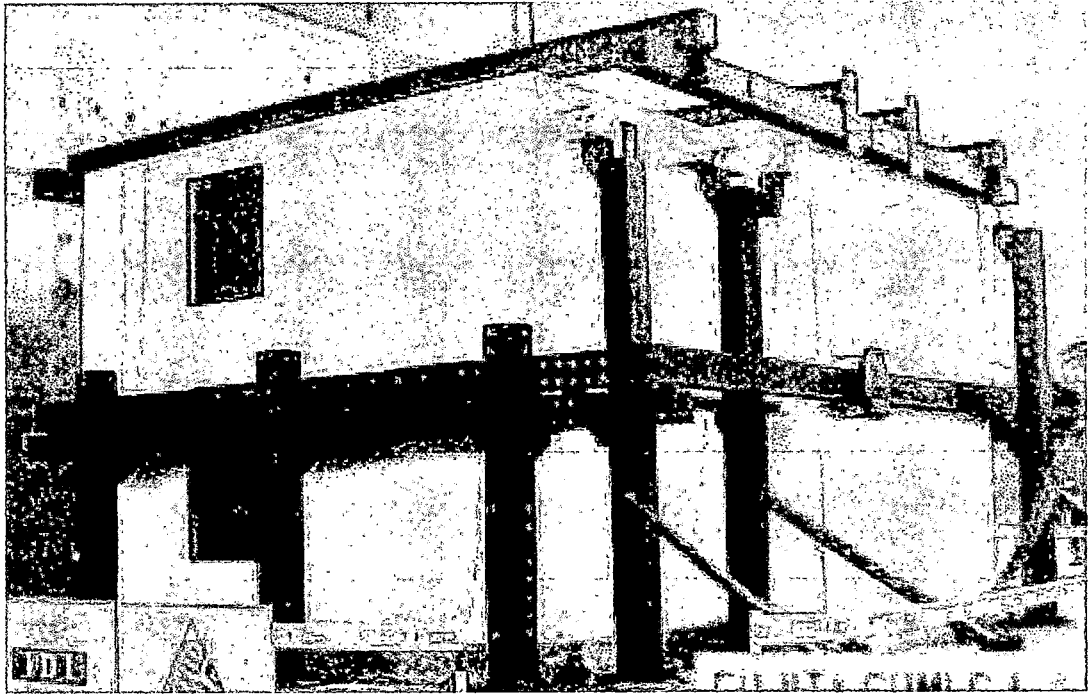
b. Vista diagonal Norte-Este de la vivienda con el kit de montaje, nótese los pernos pasantes
